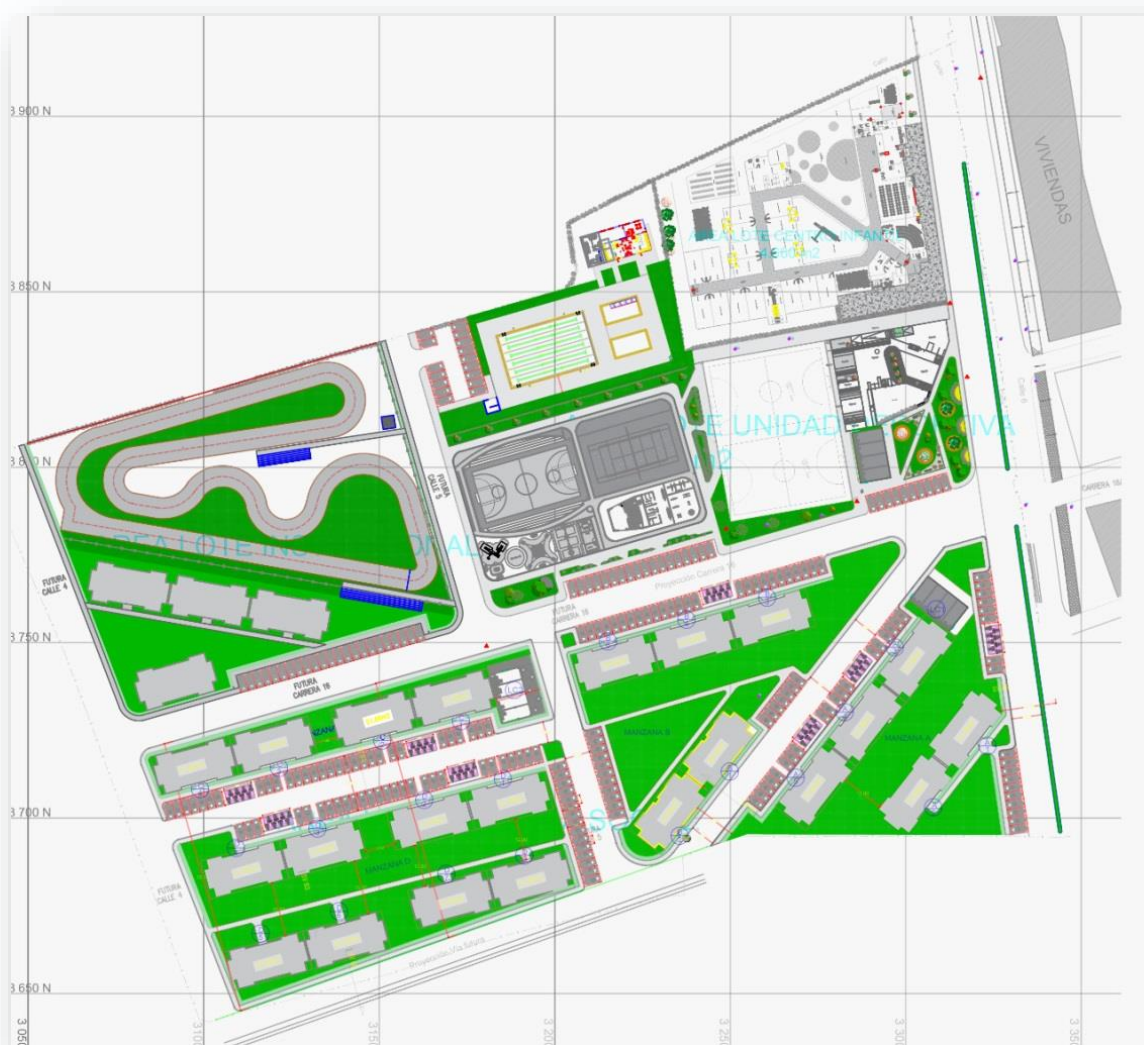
Proyección de Desarrollo zona adjunta al proyecto Sueños del Tambo
